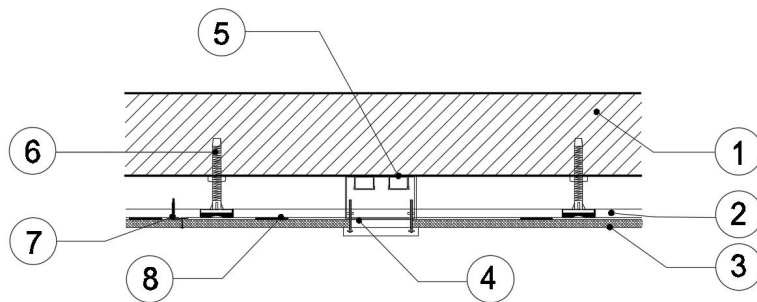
调平龙骨饰面板墙面系统构造示意图（横剖面图）
